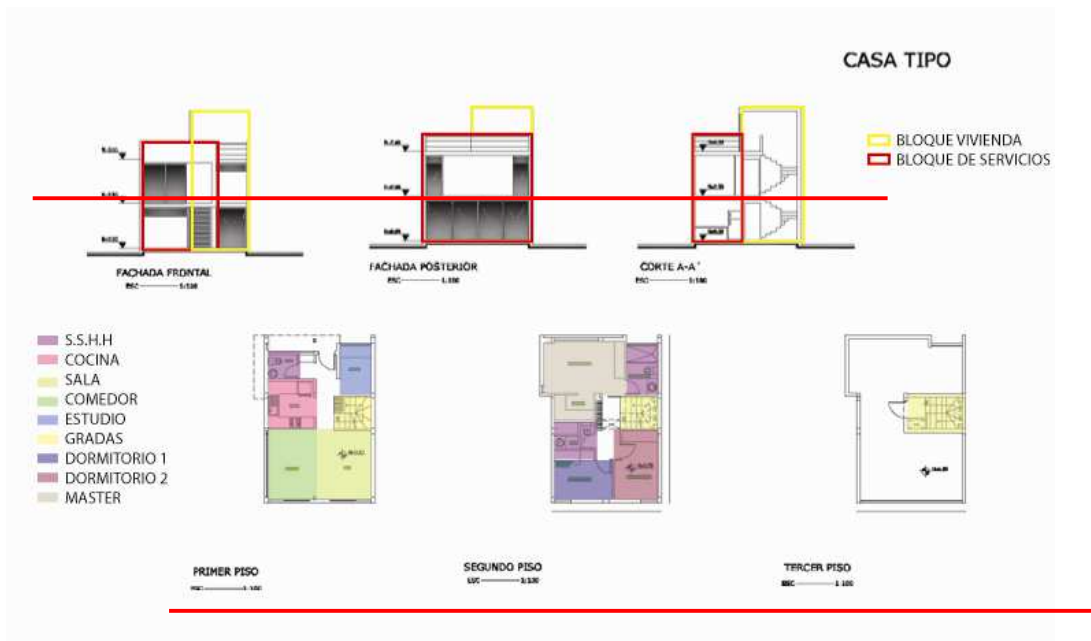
Conceptos Arquitectónicos Conjunto Villa de Leiva, Fuente: Álvarez & Castro Constructora.
